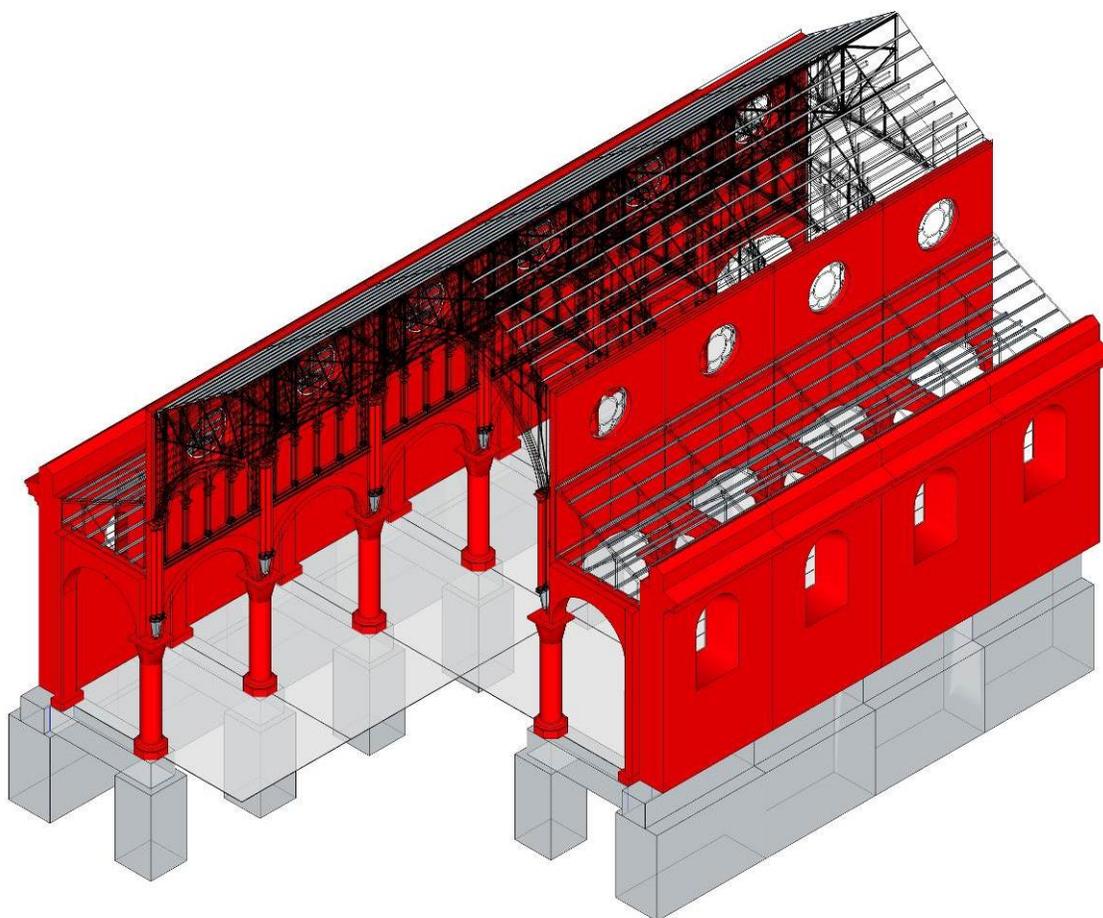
Isométrica de naves indicando en rojo sistema constructivo de albañilería de arcilla. Elab. Propia.
